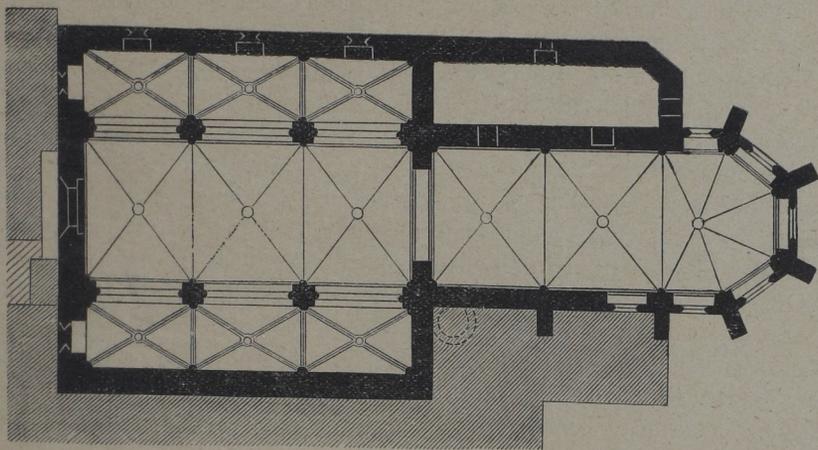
Grundriss der Heiligenkreuzkirche des Cyriakenklosters in Prag.
